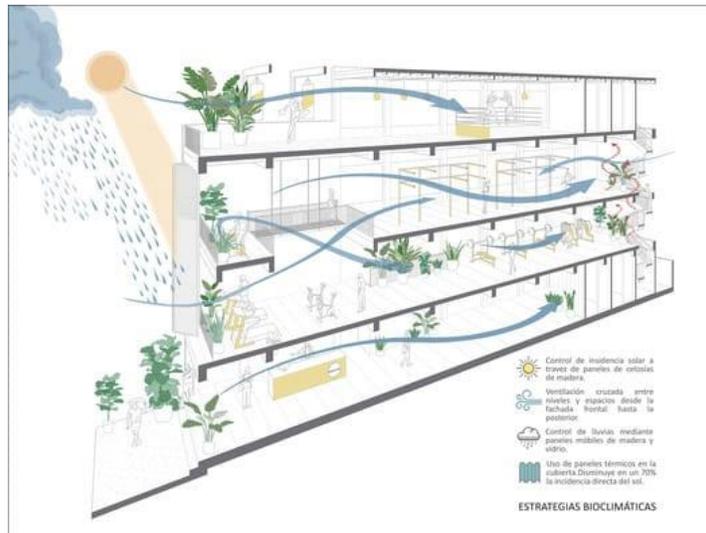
Propuesta para ventilación e iluminación por fachadas permeables
